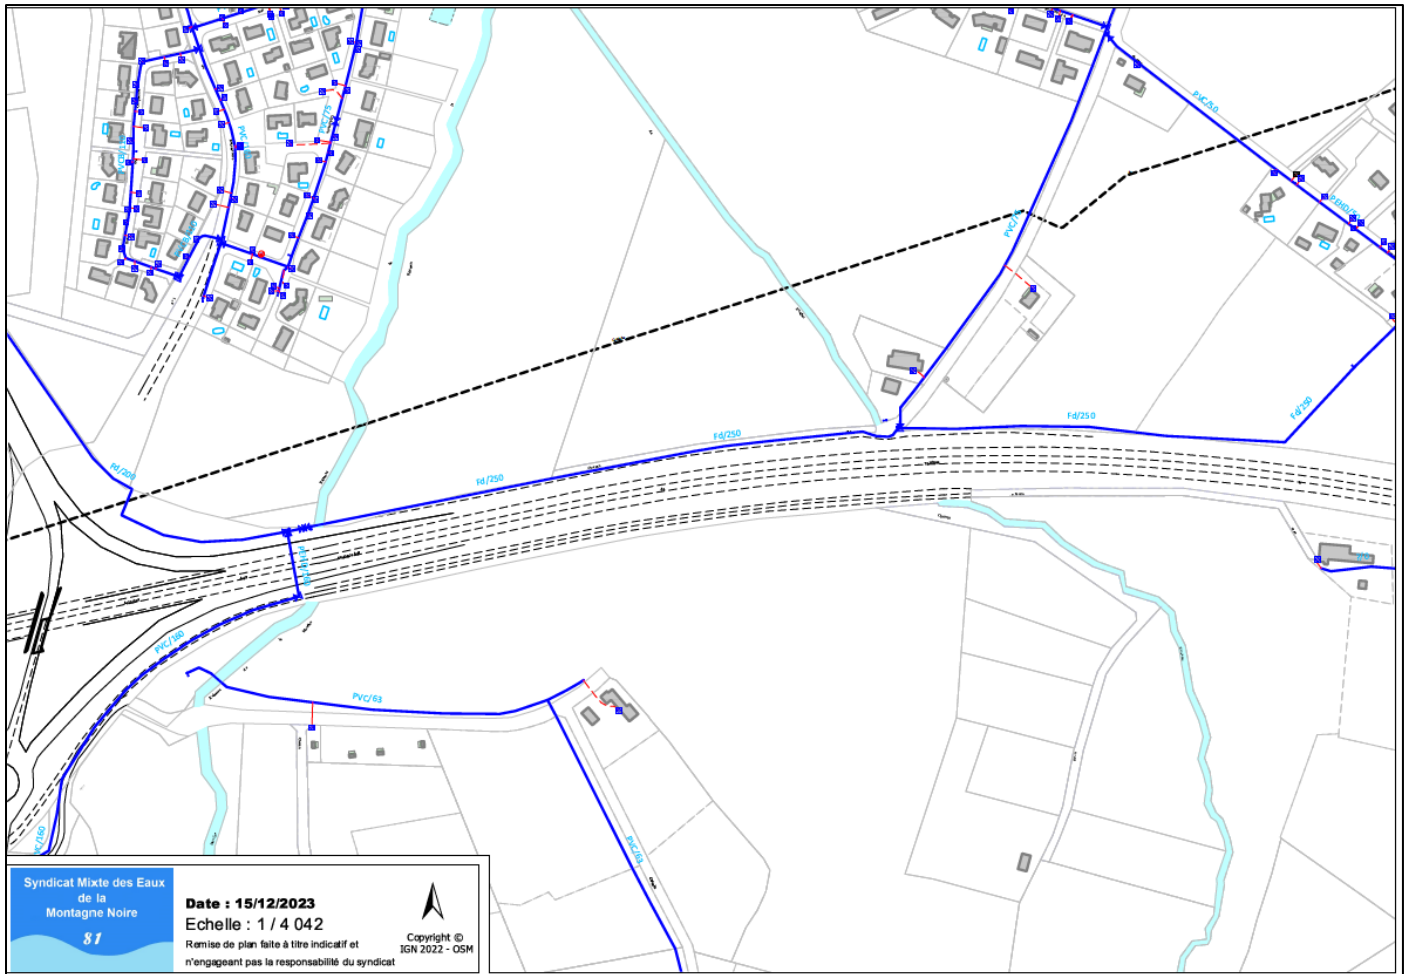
Plan de la canalisation de transport d'eau potable existante (Source : Syndicat Mixte des eaux de la Montagne Noire)
